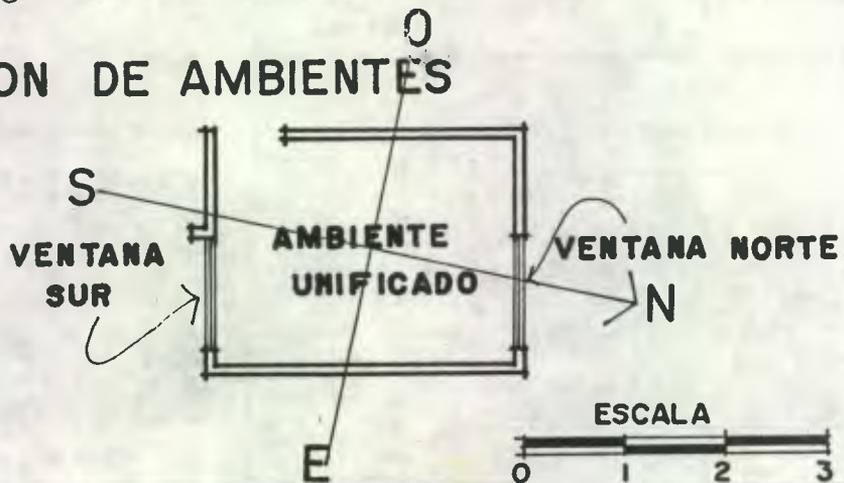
PLANTA DE LA VIVIENDA A ANALIZAR
